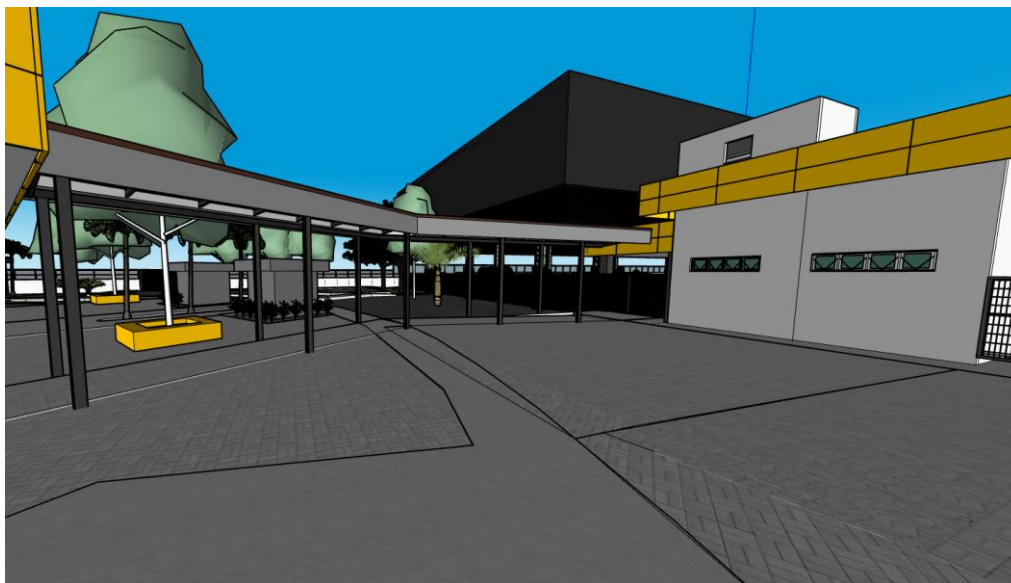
Passarela de acesso principal – em estrutura metálica com telha metálica pintada de preto RAL9005.
